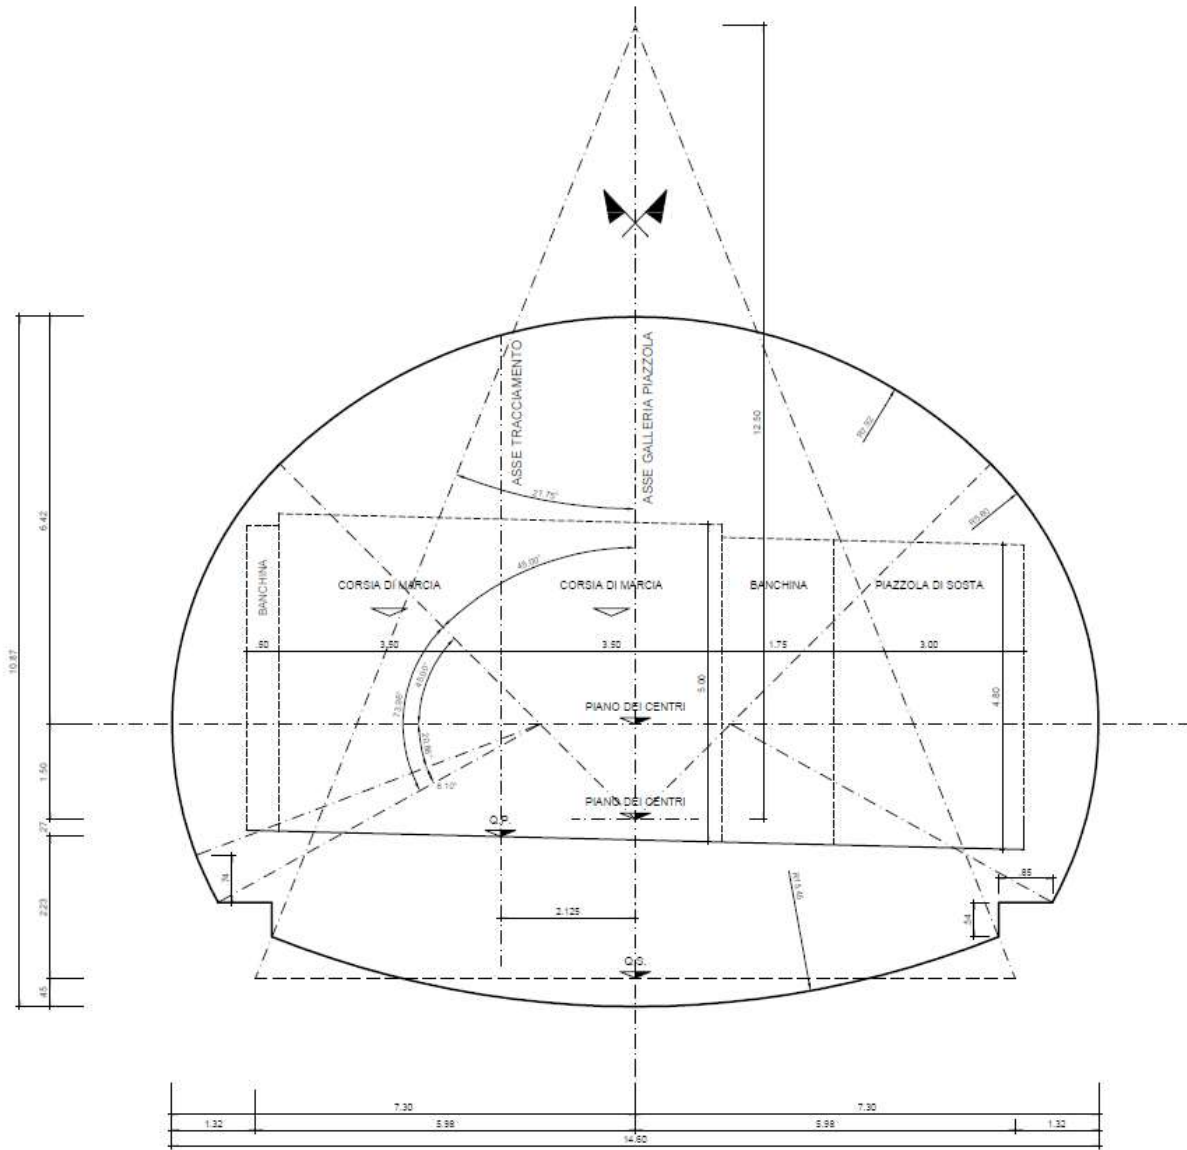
Sezione tipo piazzola funzionale galleria Casacastalda.
